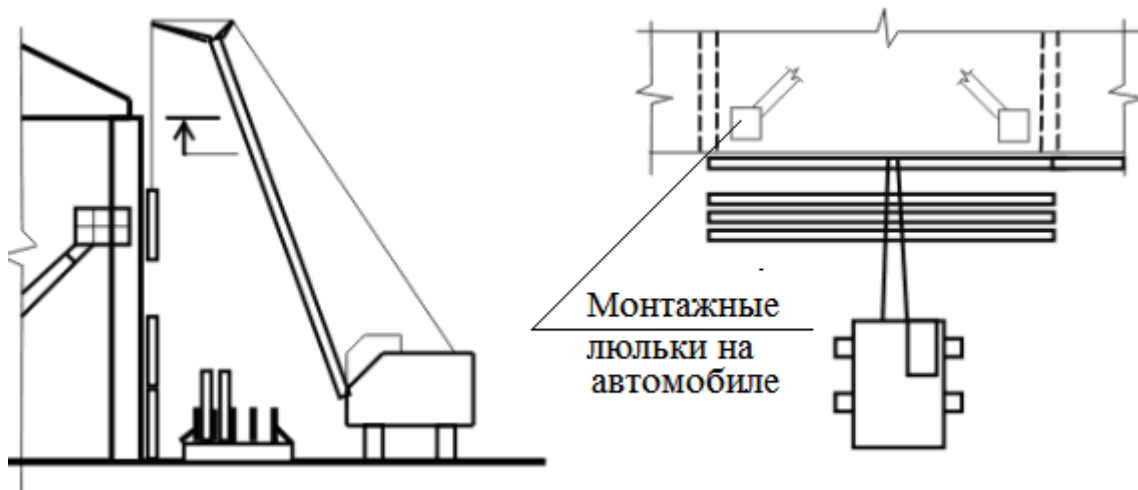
Монтаж стеновых панелей с использованием монтажных площадок на автомобилях
